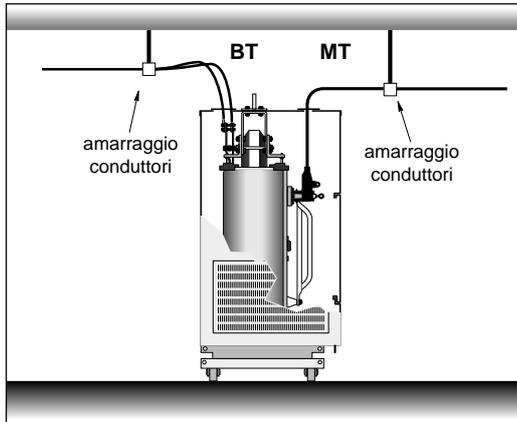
collegamenti MT e BT provenienti dall'alto.
